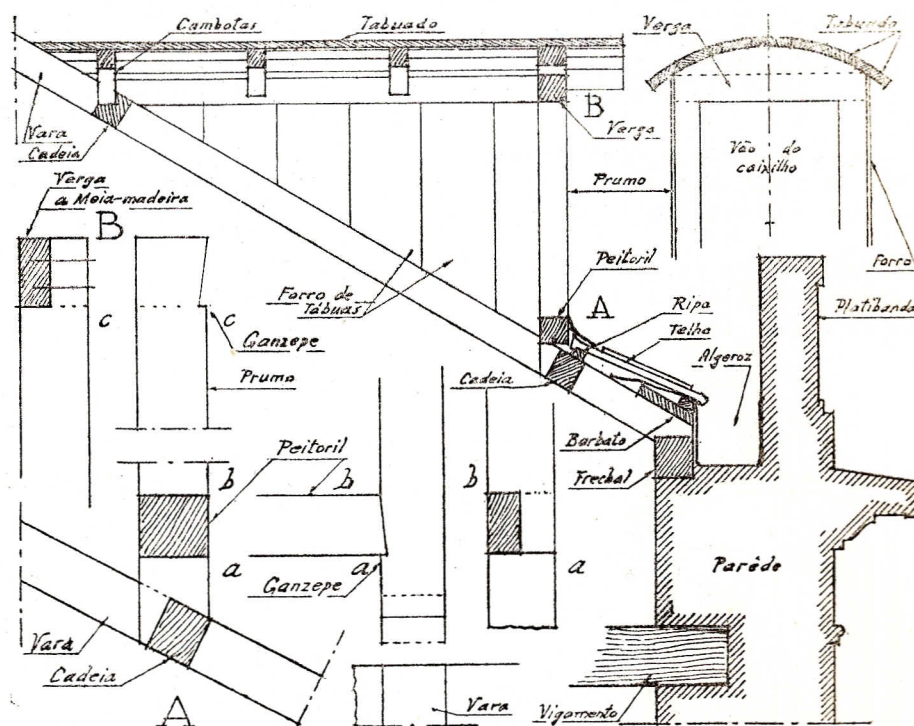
CONSTRUÇÃO DE TRAPEIRAS DE COBERTURA ARQUEADA
